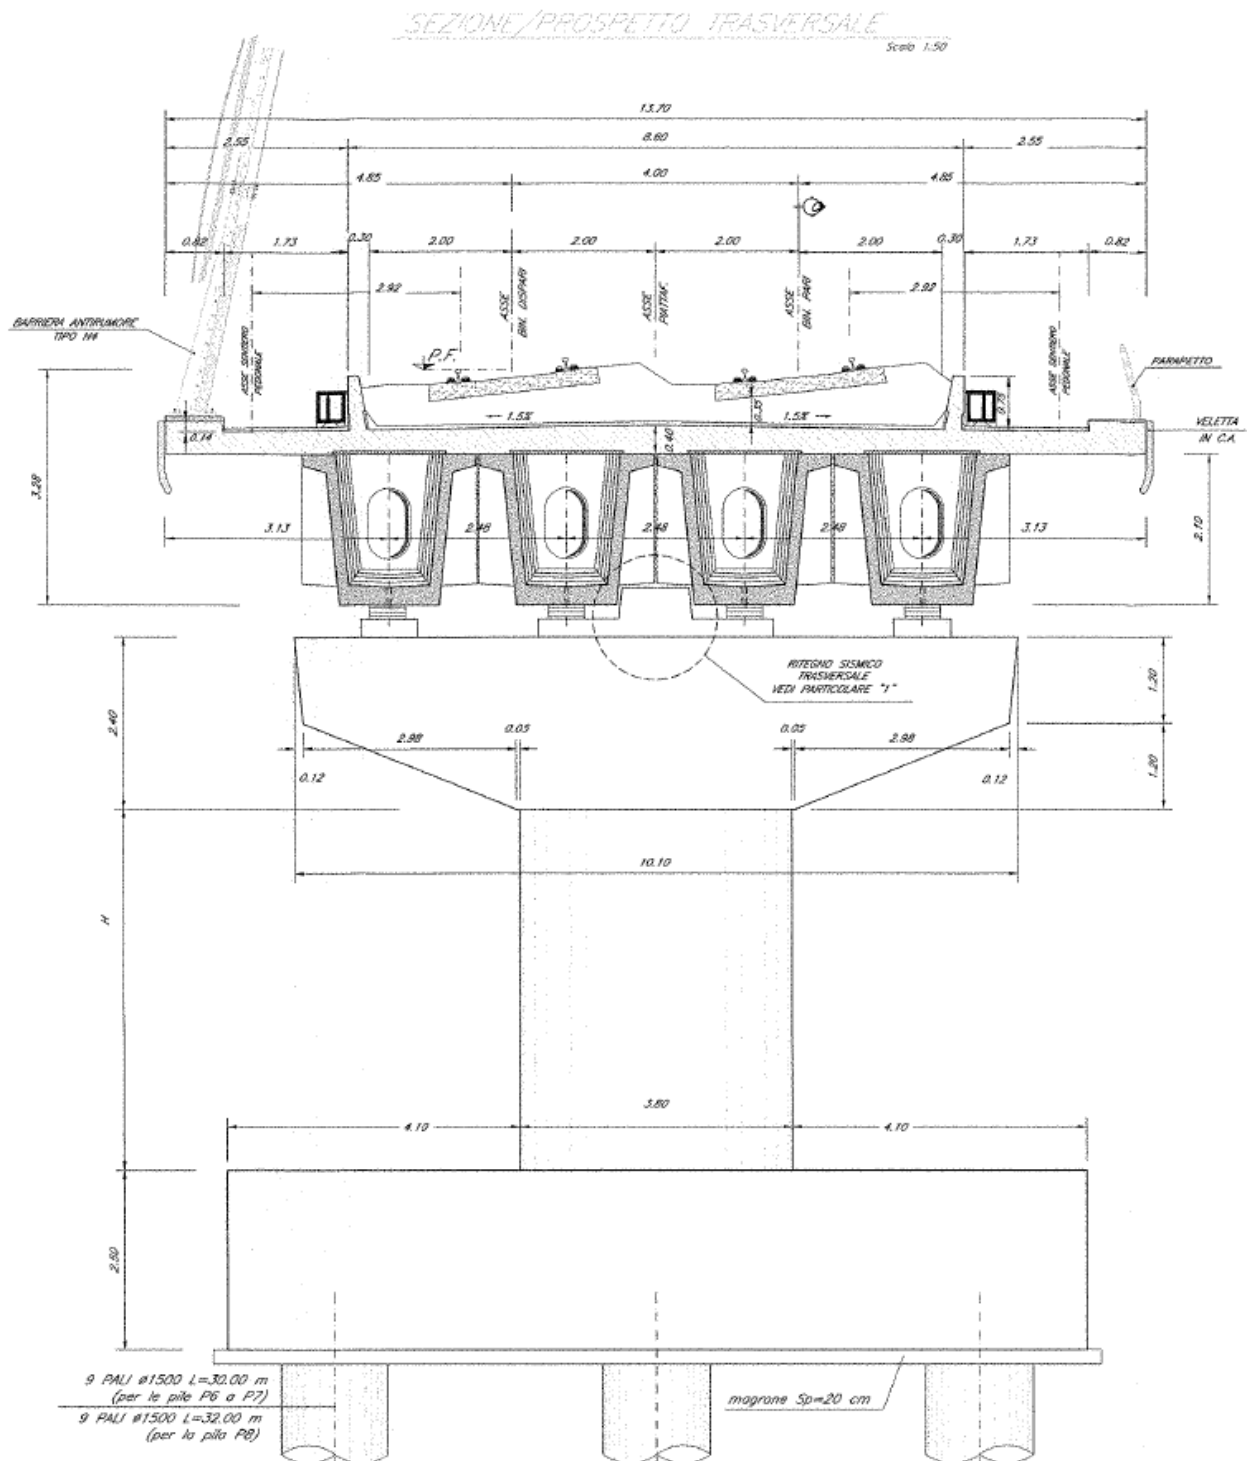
Pila, prospetto frontale – Impalcato in C.A.P. [m]
